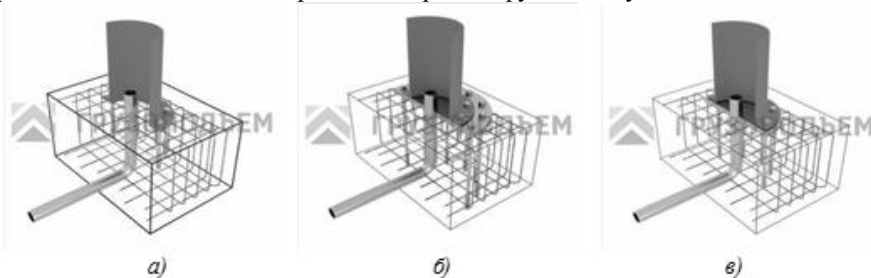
Способы крепления крана к фундаменту: а) крепление с помощью анкерных болтов непосредственно к подготовленному фундаменту; б) крепление к переходному фланцу, закрепленному с помощью анкерных болтов непосредственно к подготовительному фундаменту; в) крепление через переходной фланец с помощью анкерных болтов непосредственно к подготовительному фундаменту
